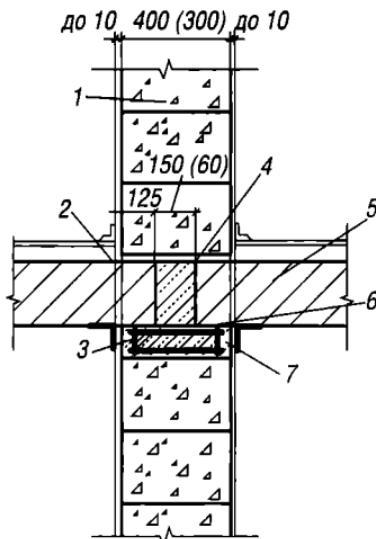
Узел опирания плиты перекрытия на внутреннюю стену из ячеистобетонных блоков:
